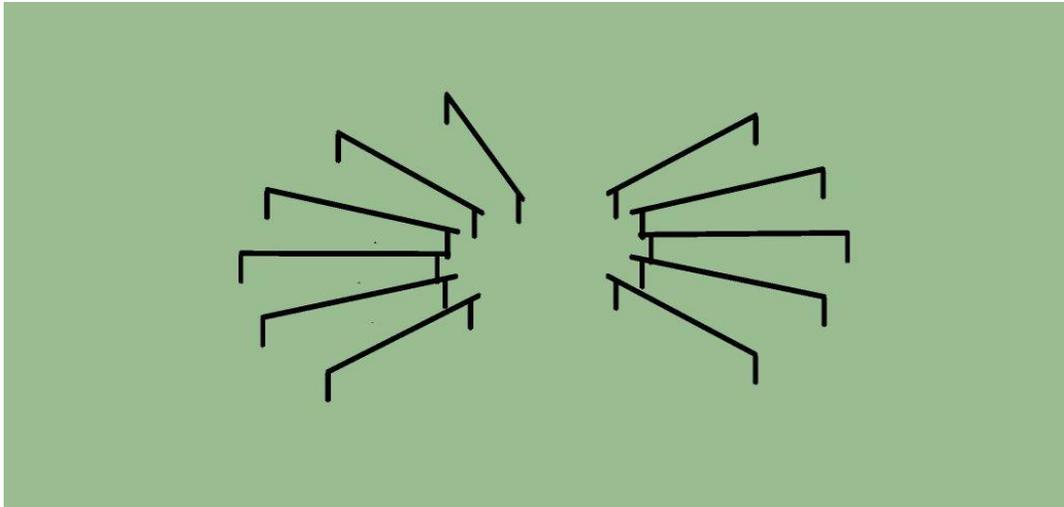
Configuración orgánica sobre la disposición de los pórticos en planta baja. Imagen propia
